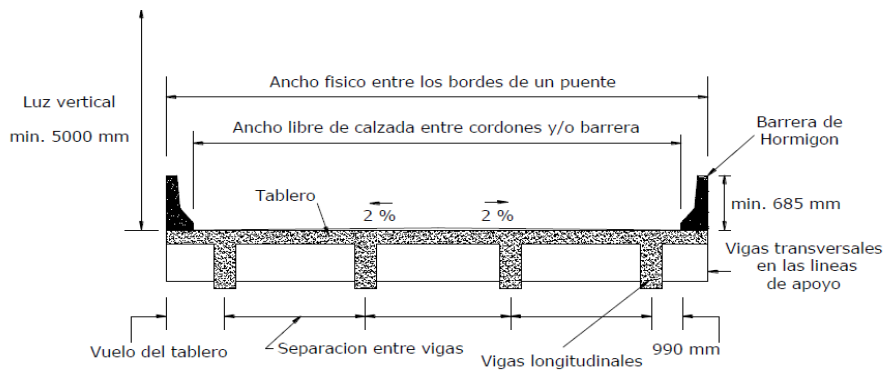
Elizabeth R. (2010). Figura Tablero y estructura portante, puente Viga-Losa. tomado de APOYO DIDACTICO EN LA ASIGNATURA DE PUENTES CIV 312
